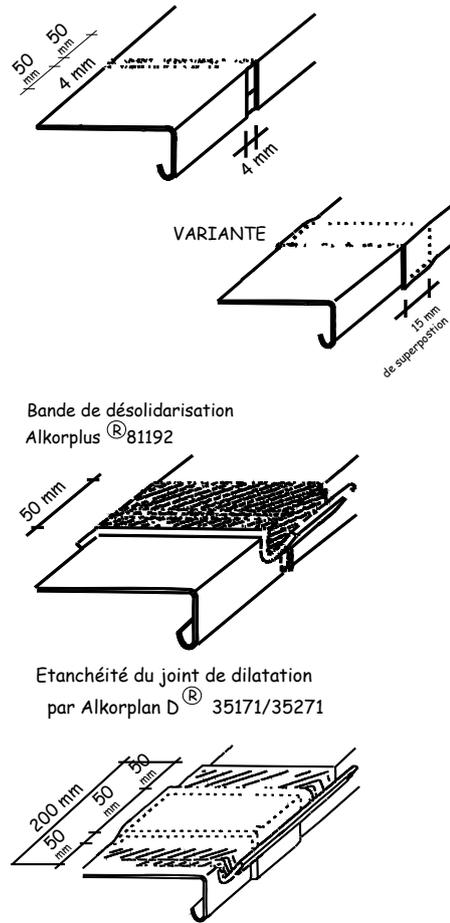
Tôle colaminée RENOLIT ALKORPLAN 81170/81171
